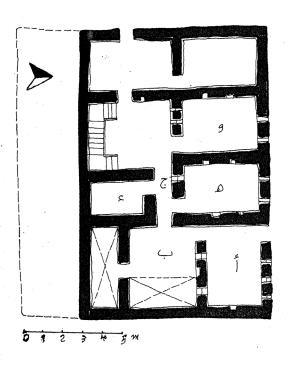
منزل ابو همام الدور الأول – مسقط أفقى
